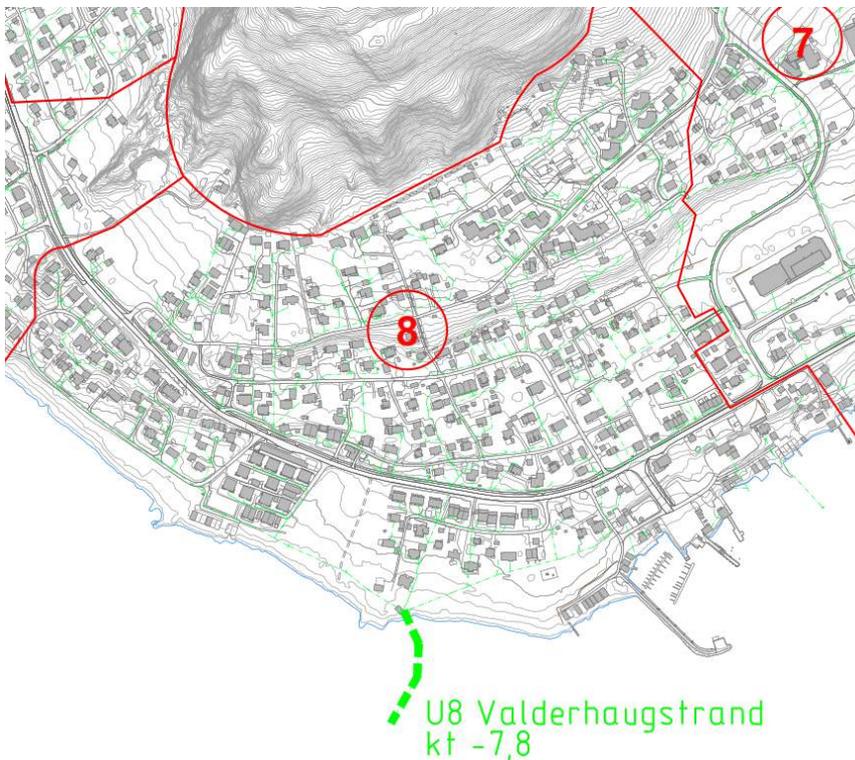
Planlagt overføringsanlegg frå eksisterande pumpestasjon PSA7 Valderhaugbakkane til RA Valderhaugstrand
